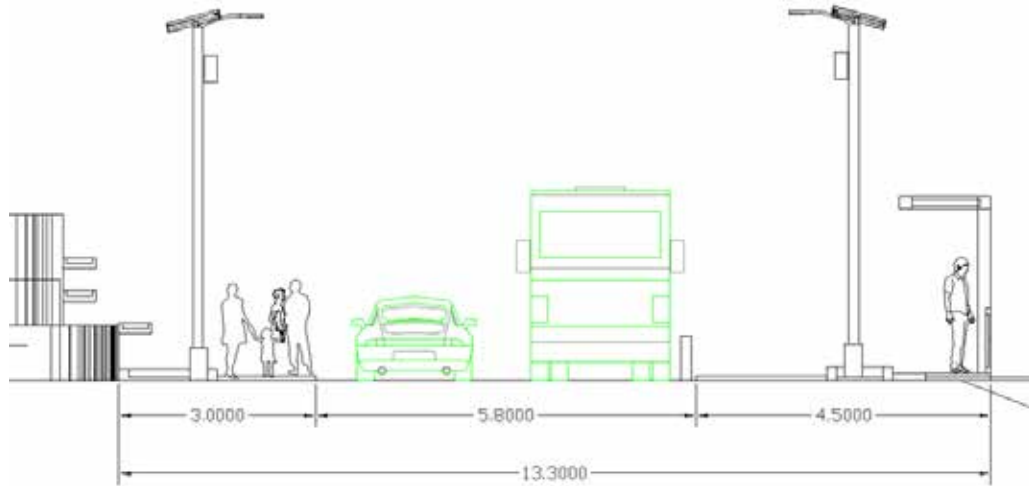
, Perfil vial Fuente: Escalante y otros (2018)
